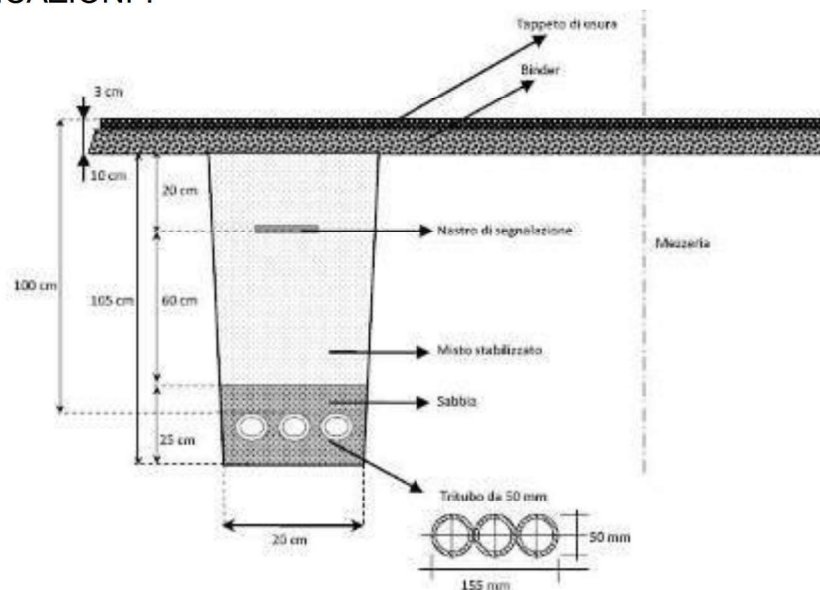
Sezione tipo scavo in trincea su sede stradale.
